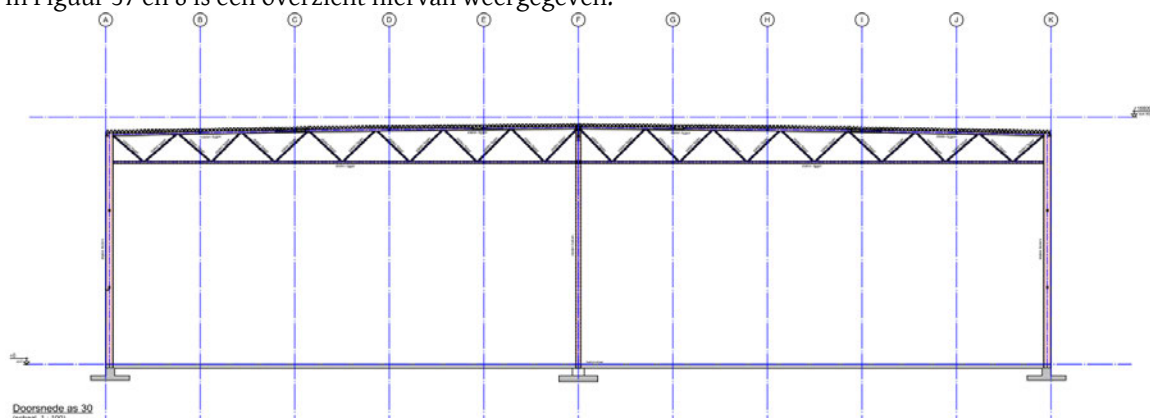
Doorsnede Deep-sorting hall (aanzicht hoofdspanten)
